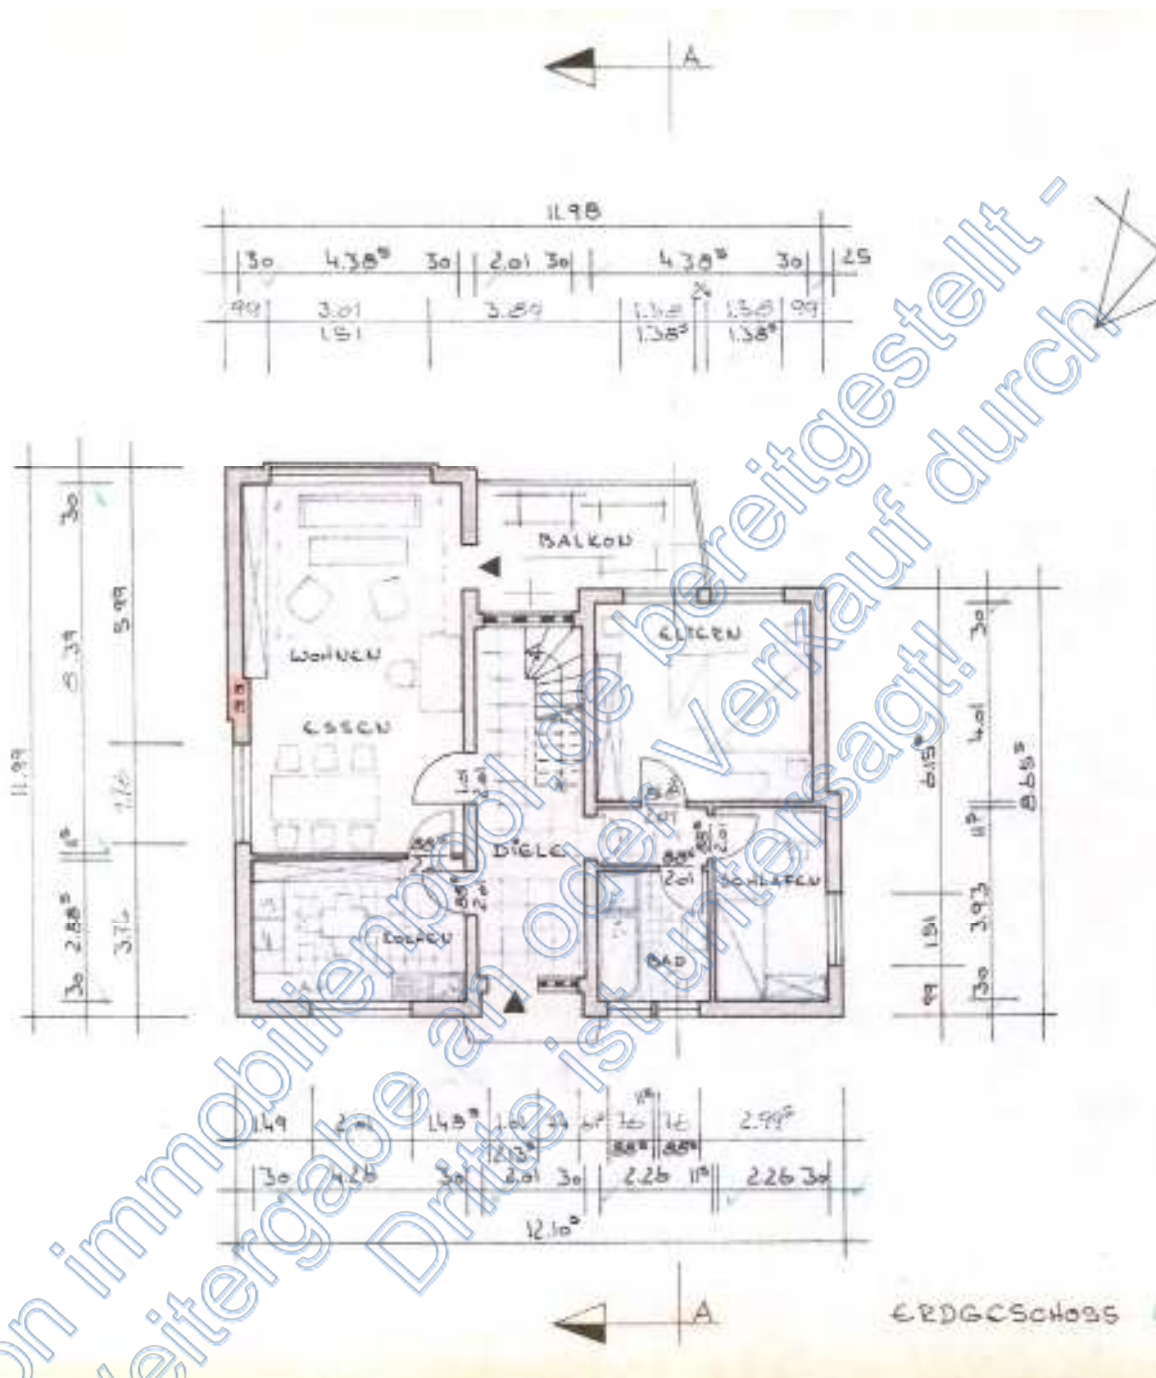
Bauzeichnung - Grundriss, Erdgeschoss
